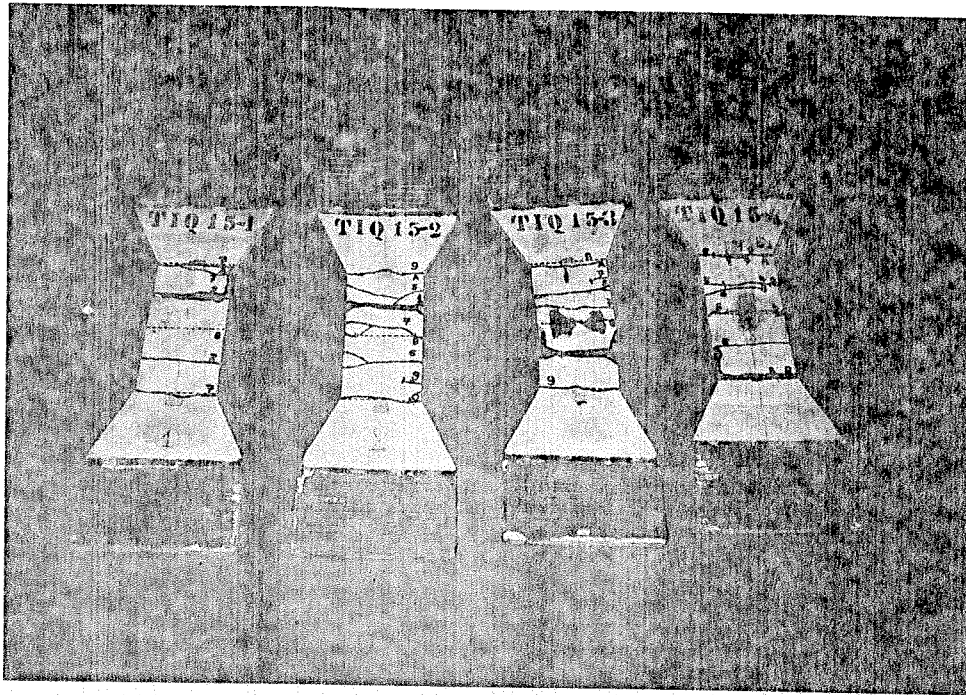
Fissuração final - Série TIQ15 (face 1 - regiões A e B)
